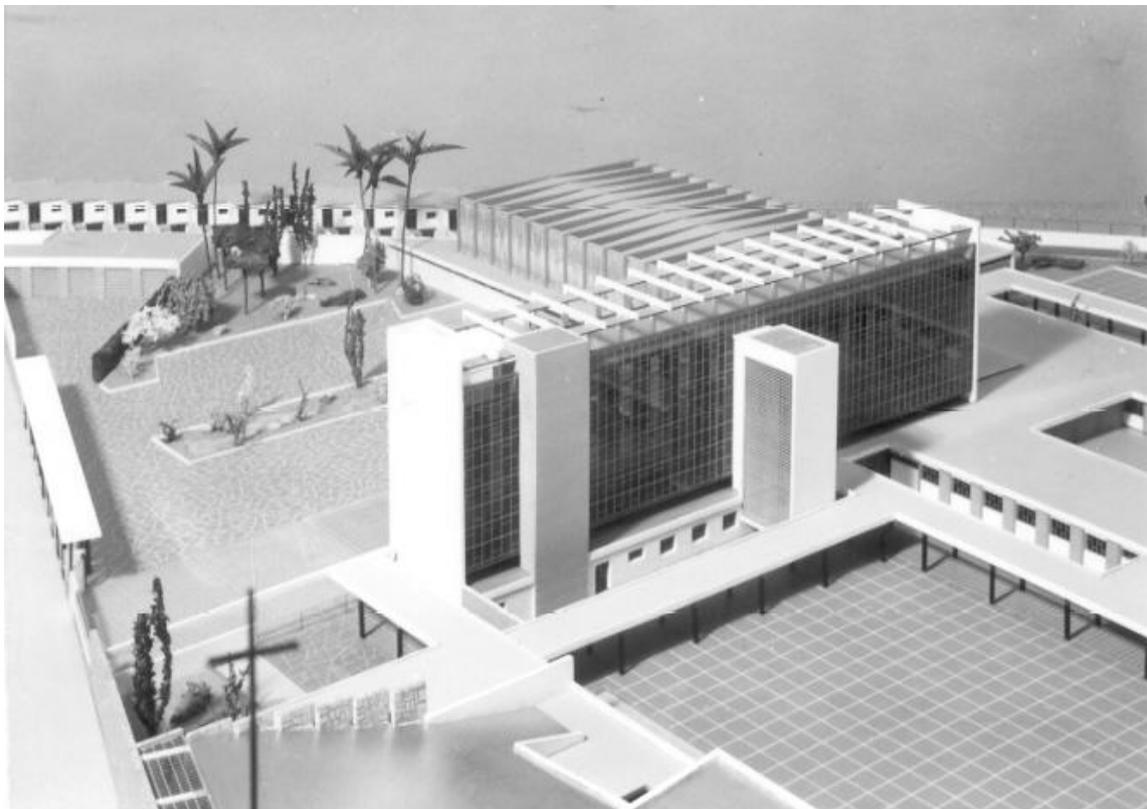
Imagen maqueta Escuelas San José, vista del edificio de entrada y al fondo salón de actos y viviendas. [Archivo Escuelas San José](#).
